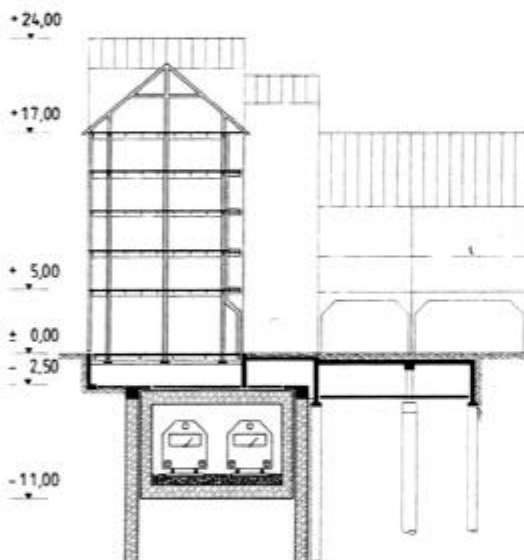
Schnitt durch Haus und S-Bahn-Tunnel
